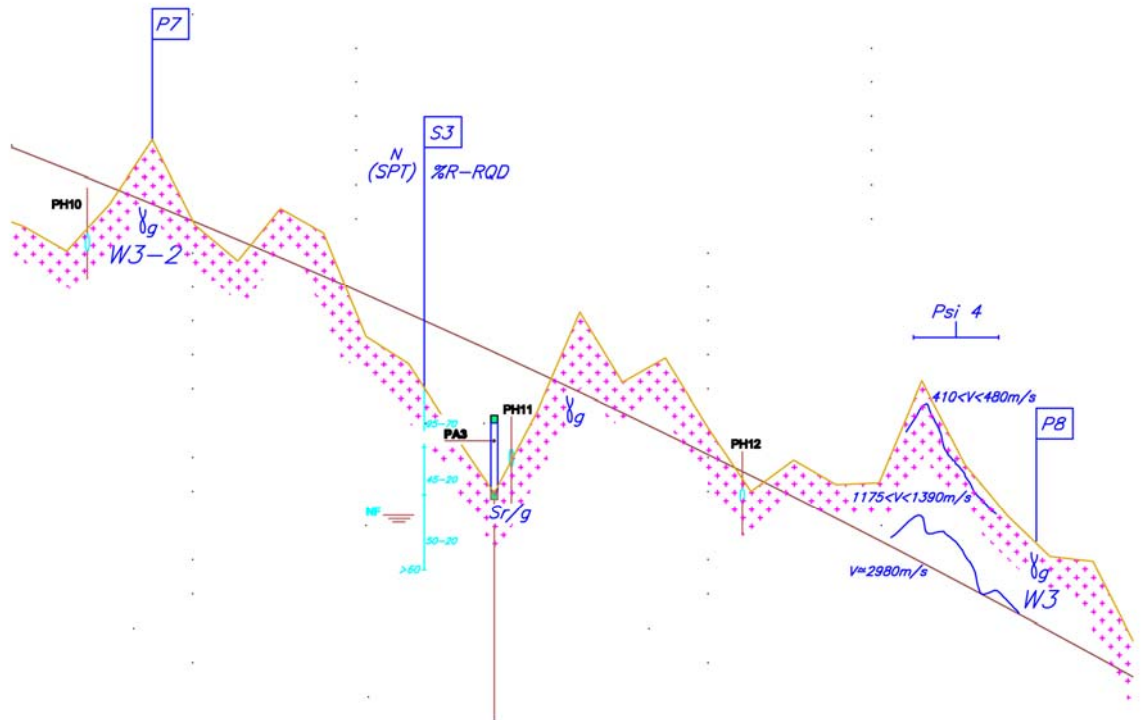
Planta de localização: constrangimentos topográficos e perfil geotécnico da obra (adaptado de Ferreira & Pereira, 2003).
